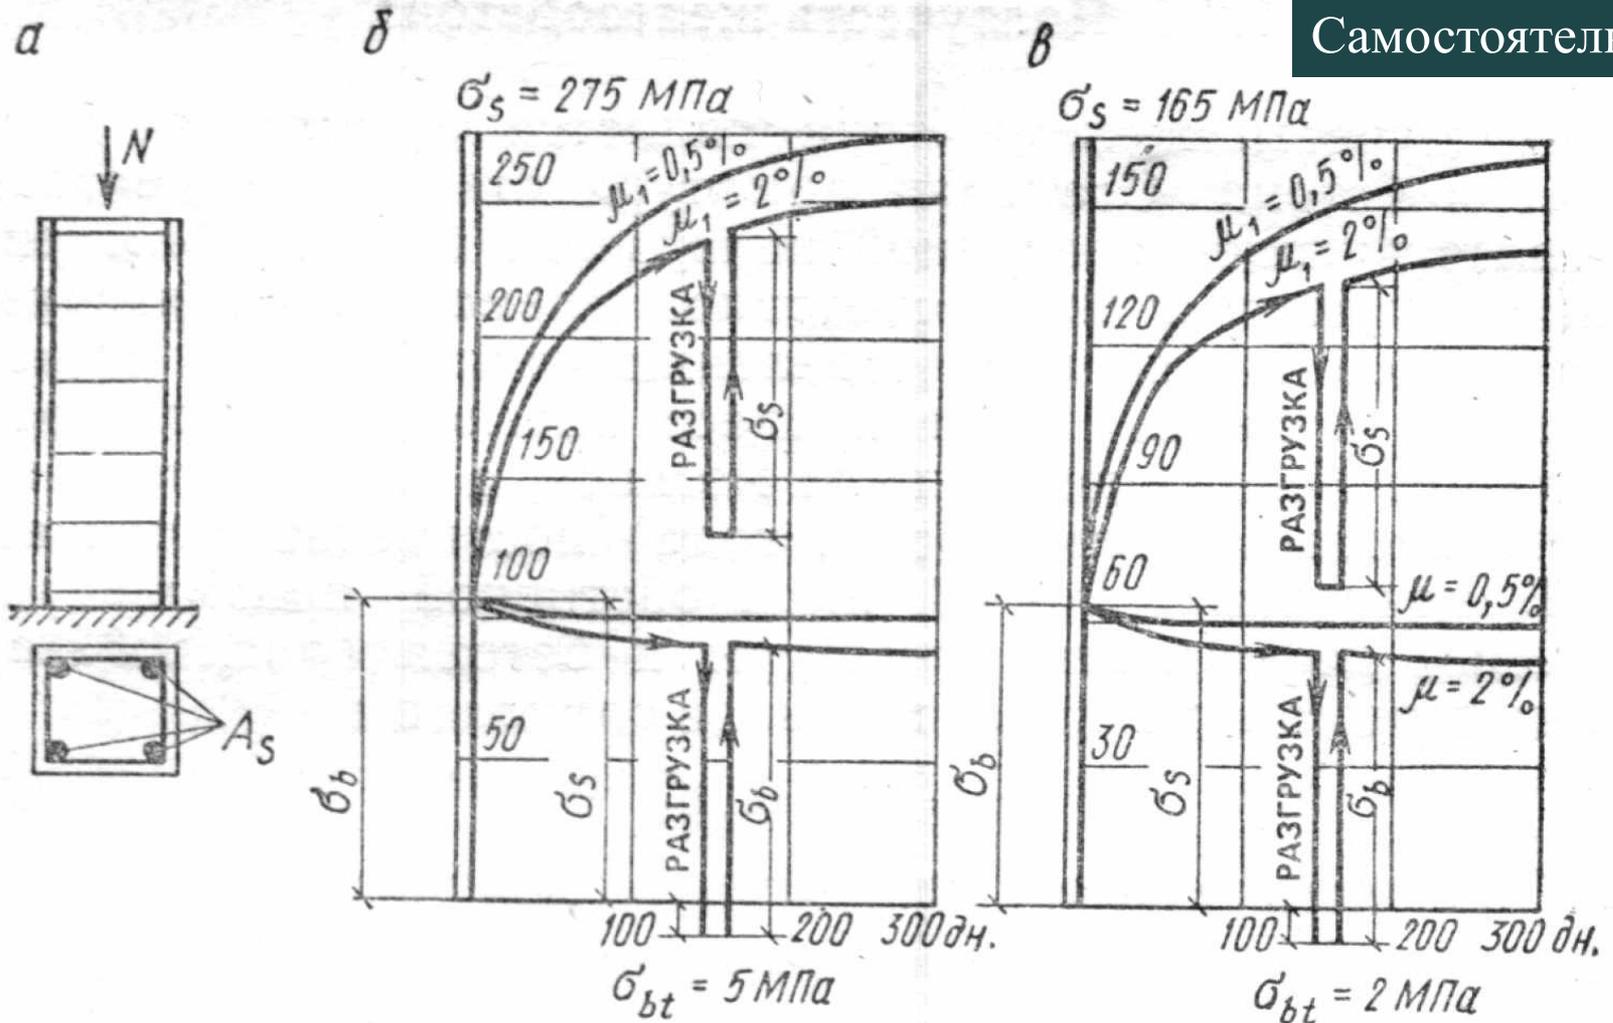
Перераспределение напряжений между арматурой и бетоном сжатой железобетонной призмы вследствие ползучести бетона
